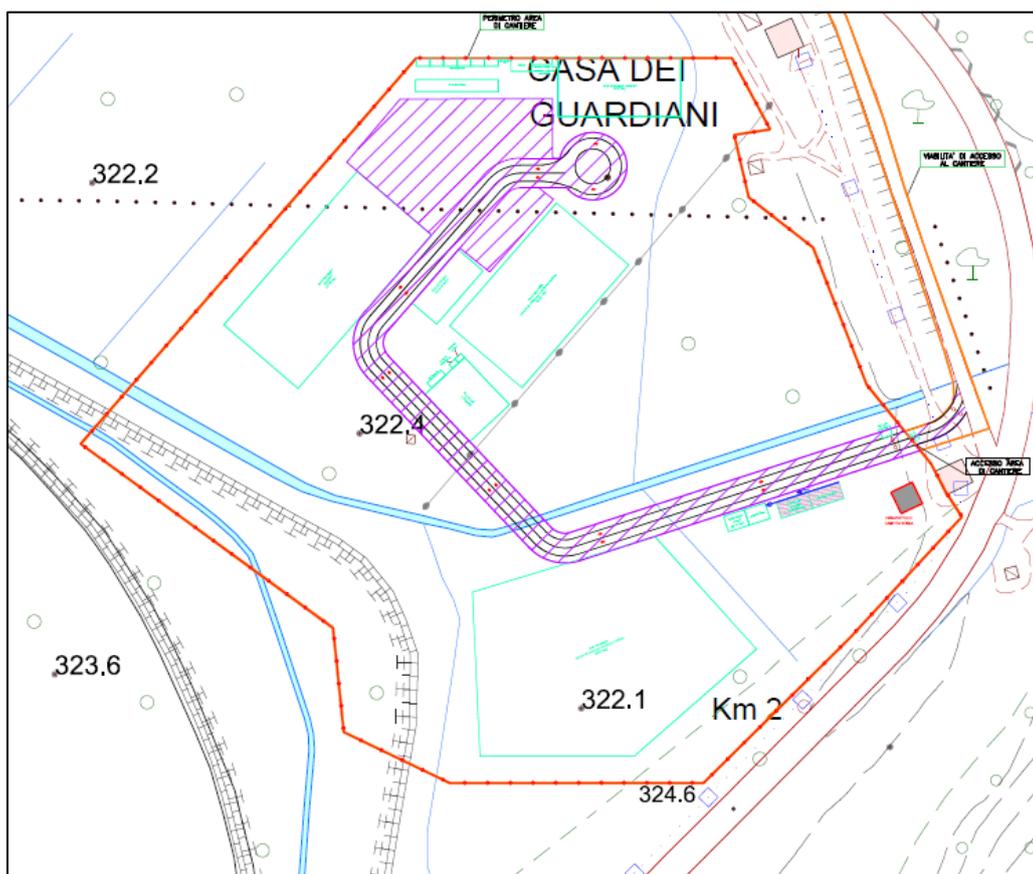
Stralcio planimetrico area di cantiere Manufatto di Casetta Rossa
